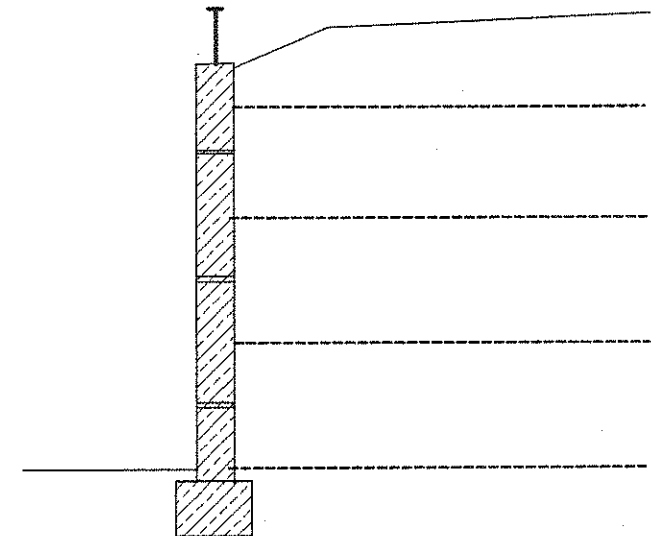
Bewehrter Erdkörper mit einer Außenhaut aus Betonplatten
